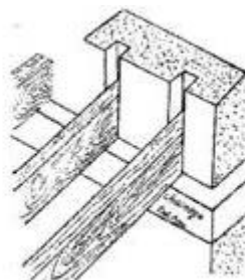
Encastrement des poutres en bois dans un mur en pisé
